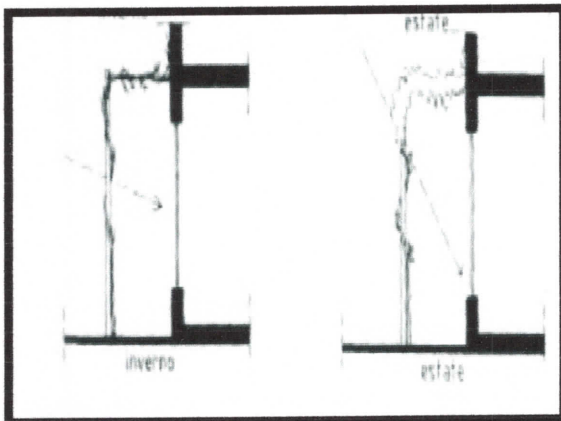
protection solaire par pergola, source: (Loïc MARCHETTO, et autre).
